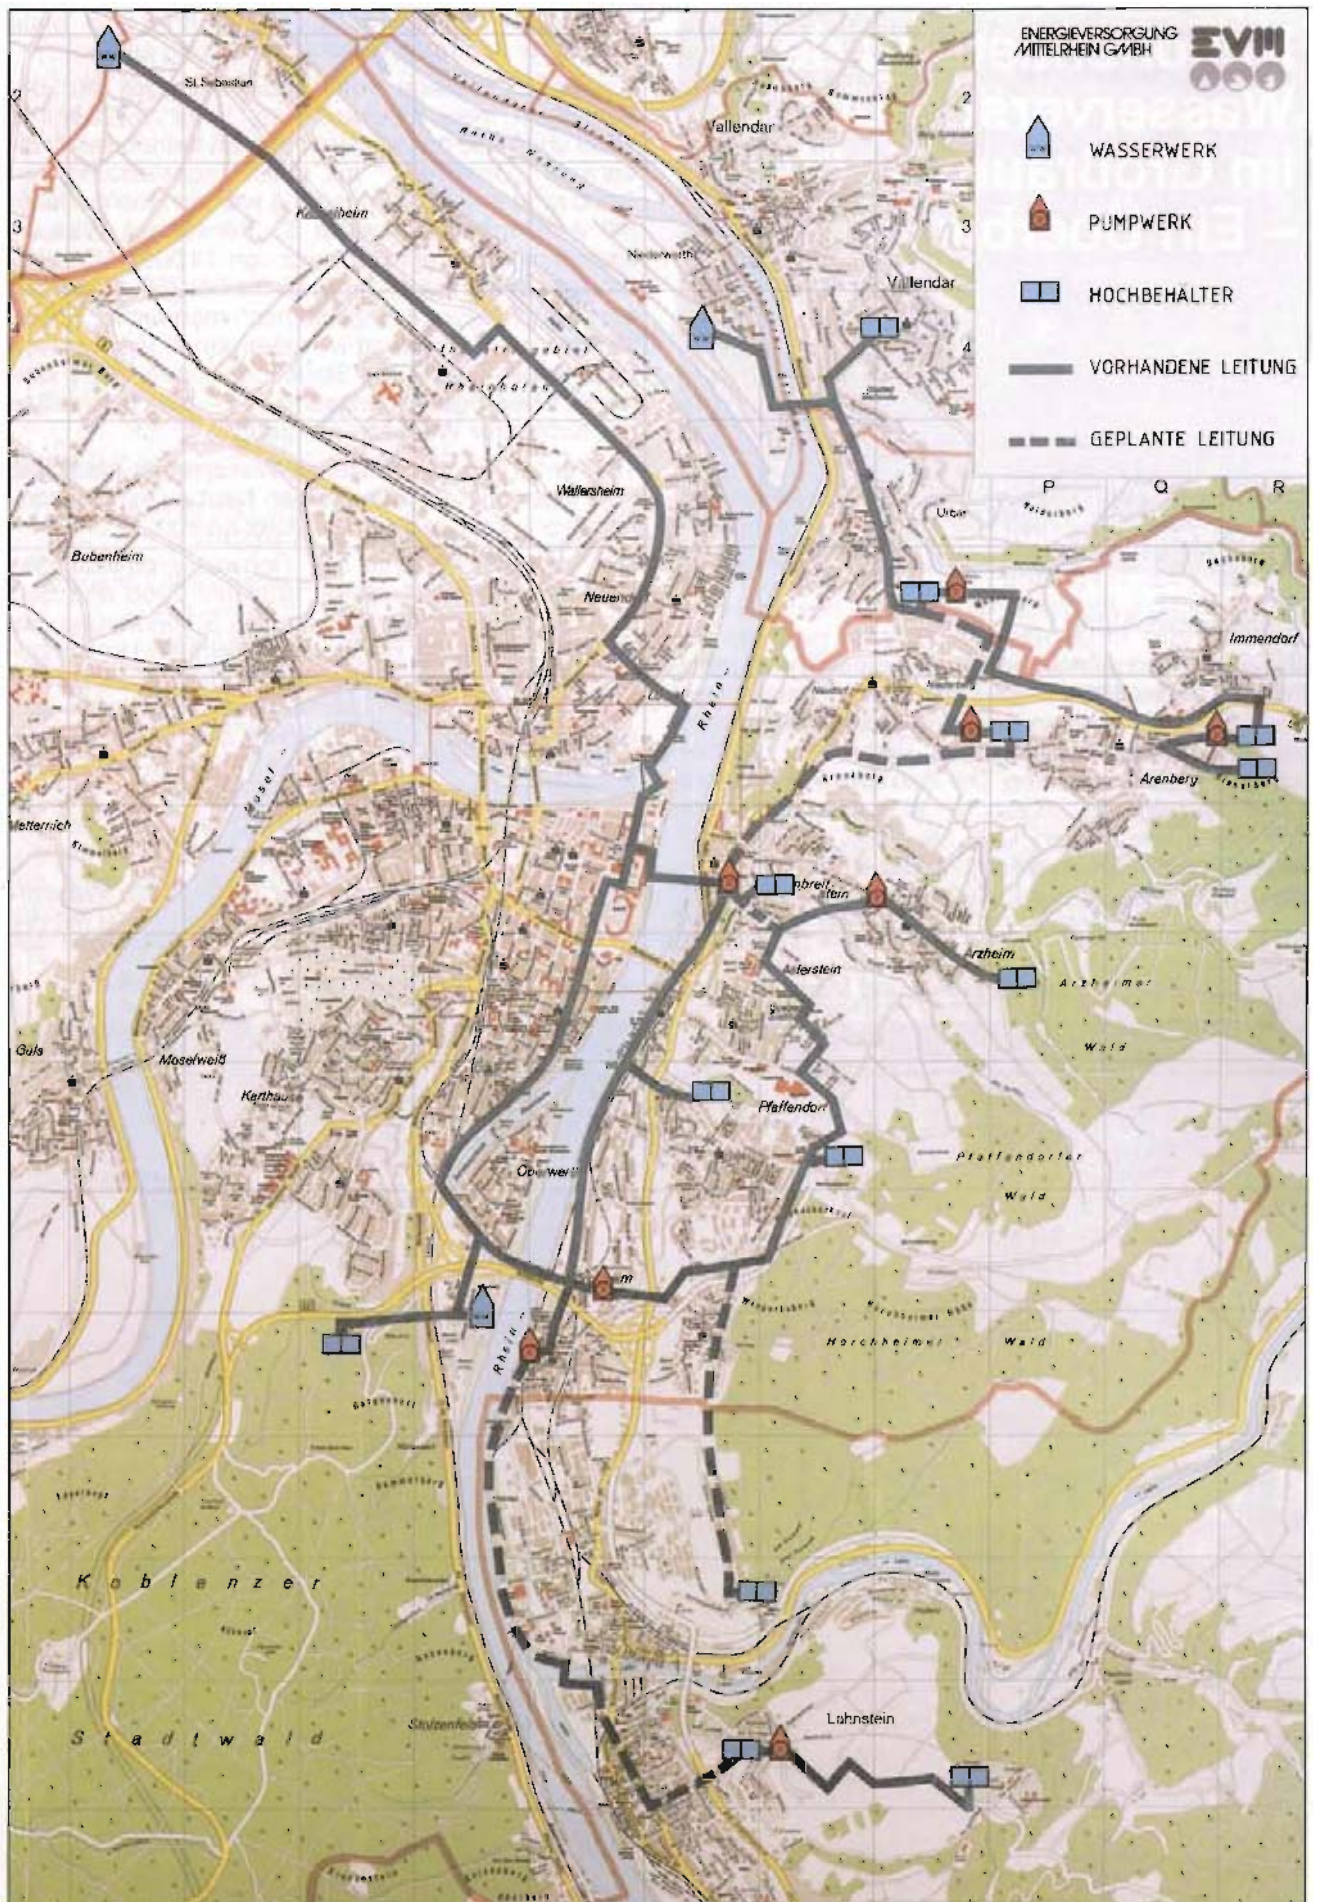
Übersichts-Lageplan mit den wesentlichen Hauptanlagen
